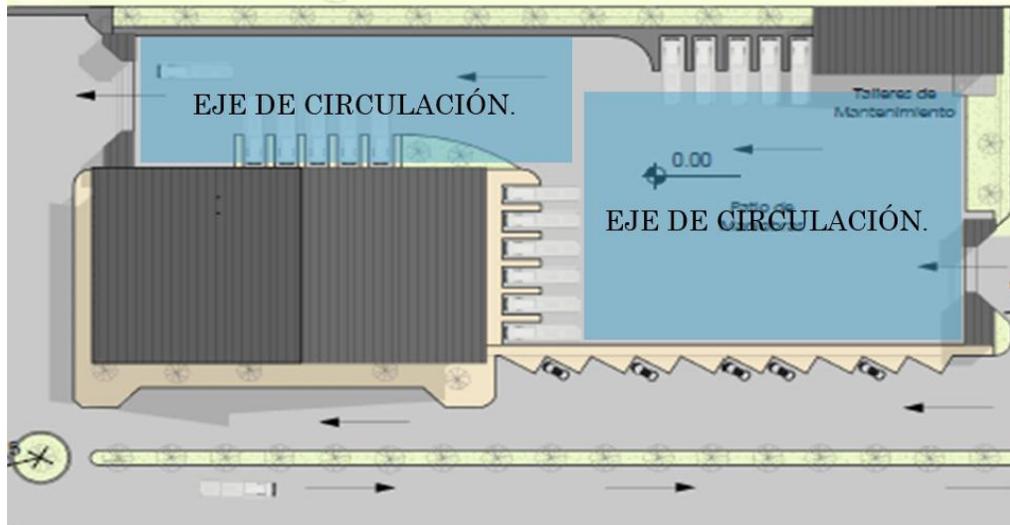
Planta Baja de la Propuesta de la Terminal Terrestre.
